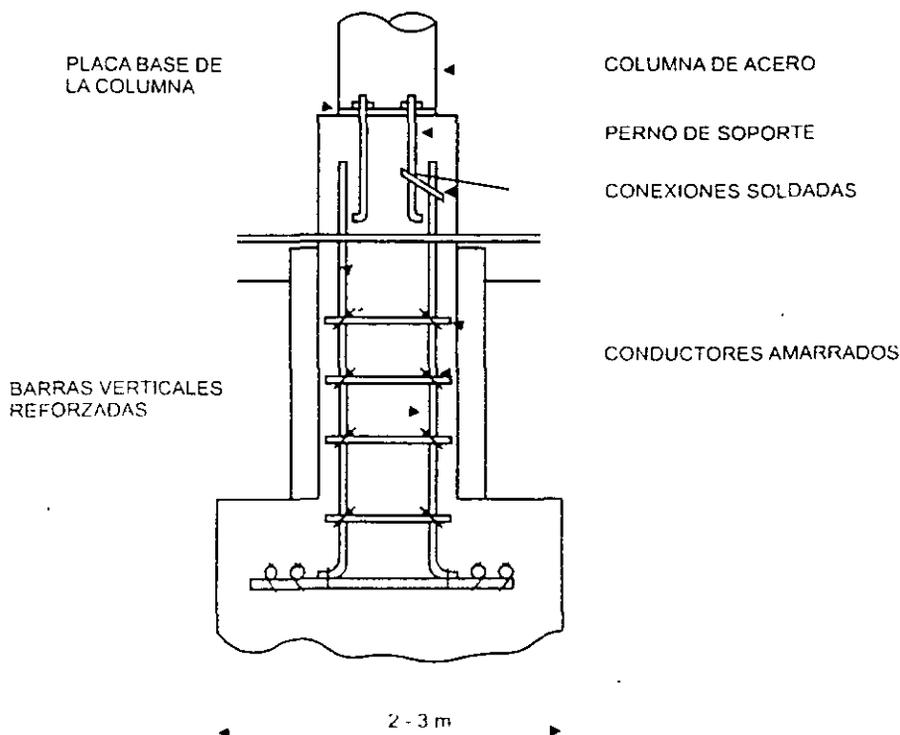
BASE DE CONCRETO REFORZADO PARA UNA COLUMNA DE ACERO
